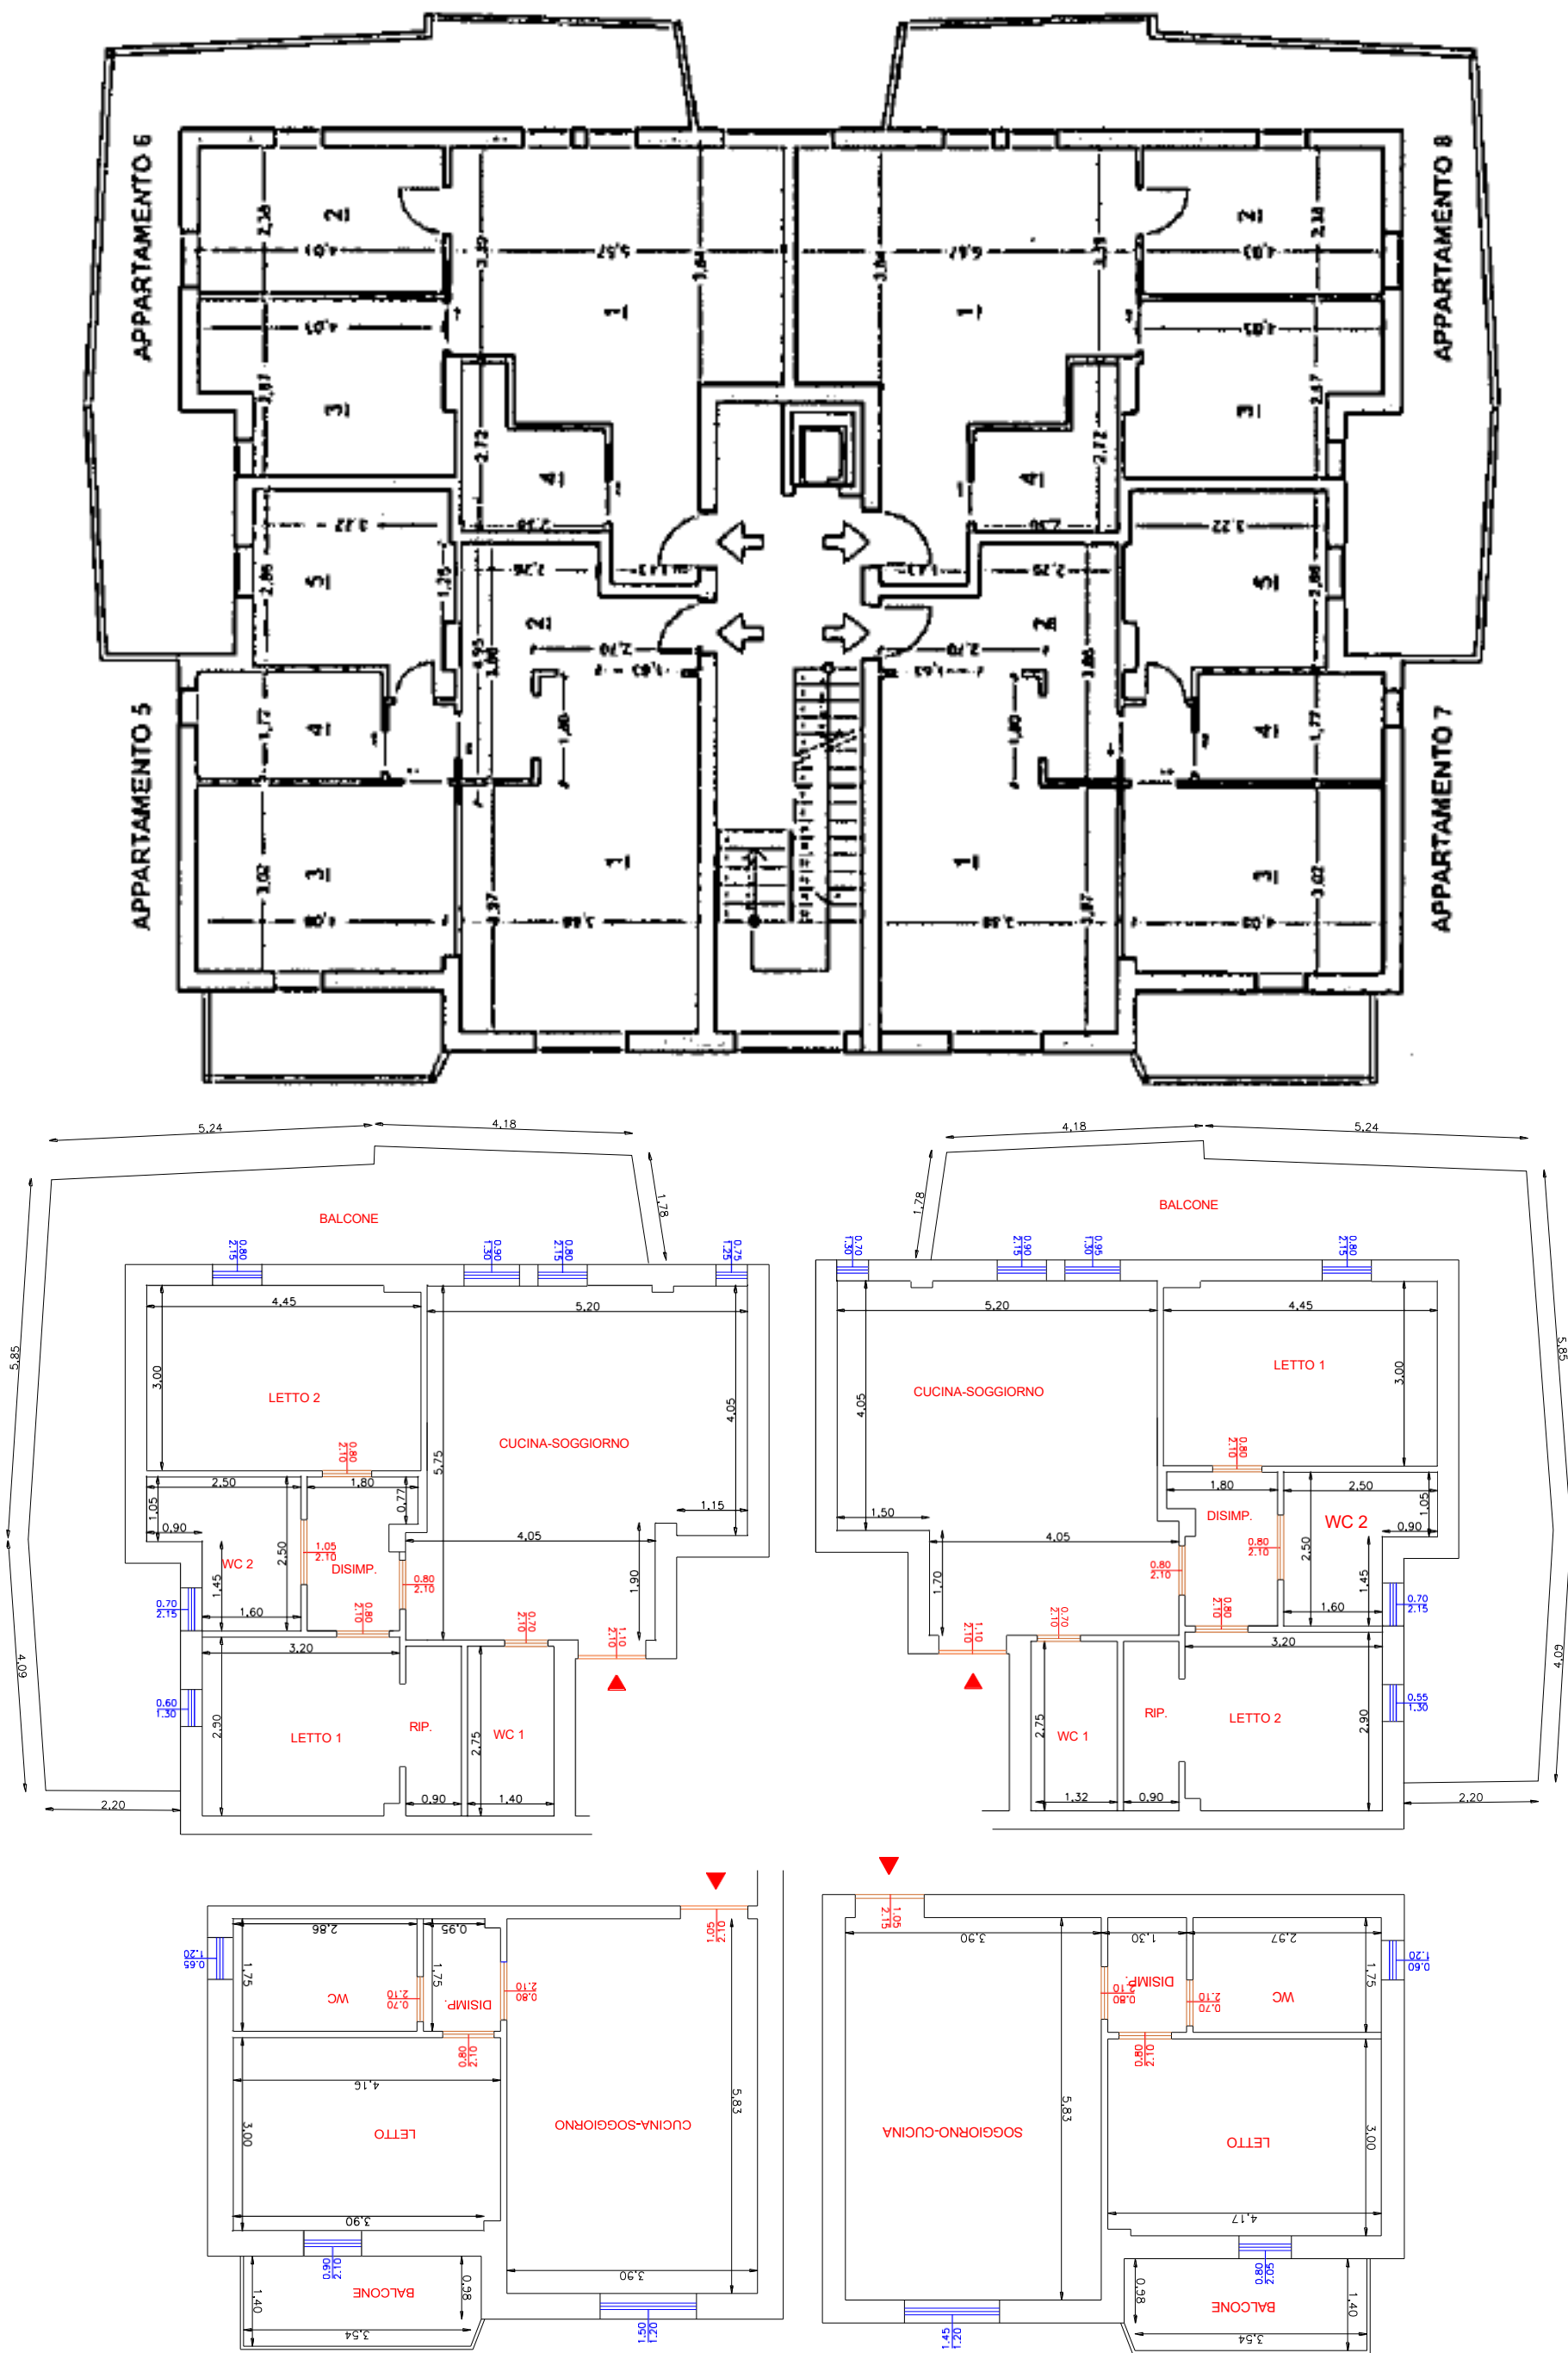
Raffronto planimetrie progettuali di cui alla CILA protocollo n. 37264 del 21/04/2020 (sopra) e planimetrie d'origine (sotto) - PIANOTERZO
